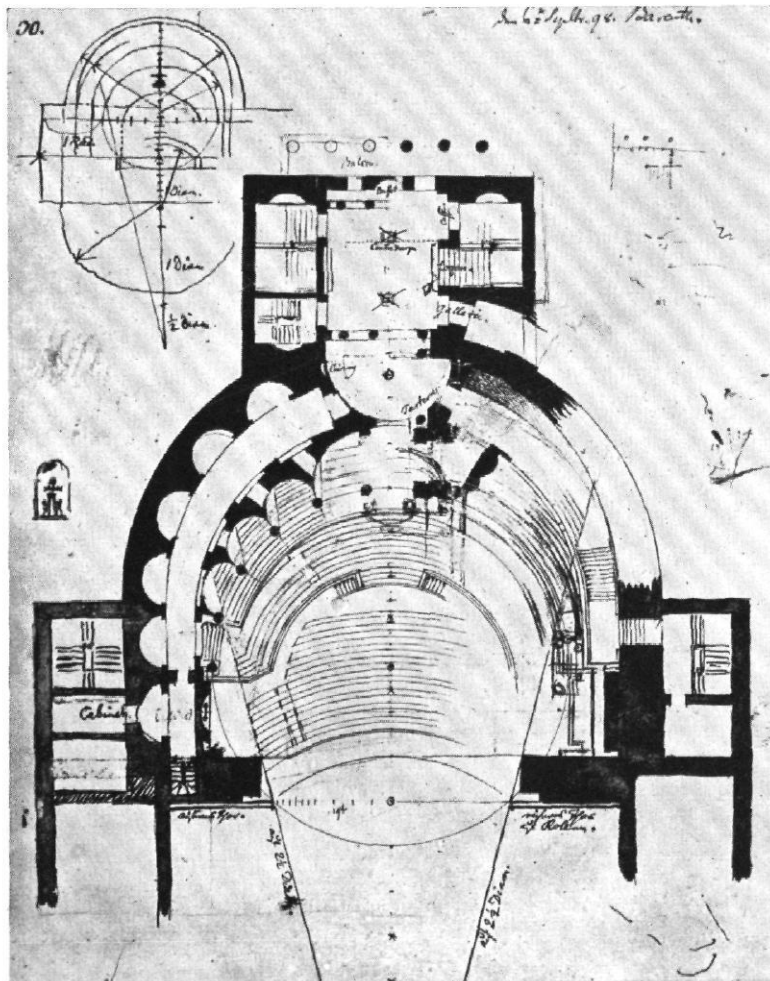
/ Friedrich Gilly / Entwurf eines Schauspielhauses / Grundriß
